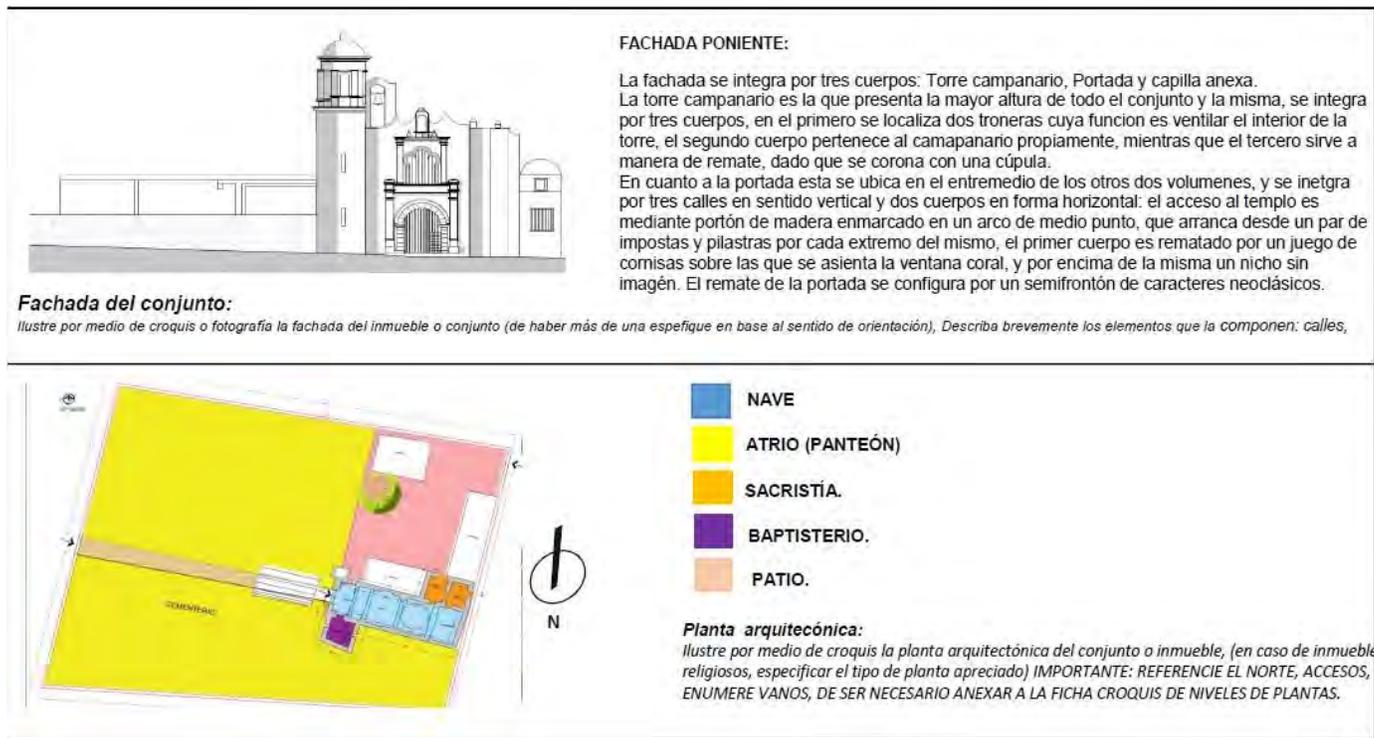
Ficha de levantamiento de deterioro, apartado 4. Elaboración propia. (2018)
